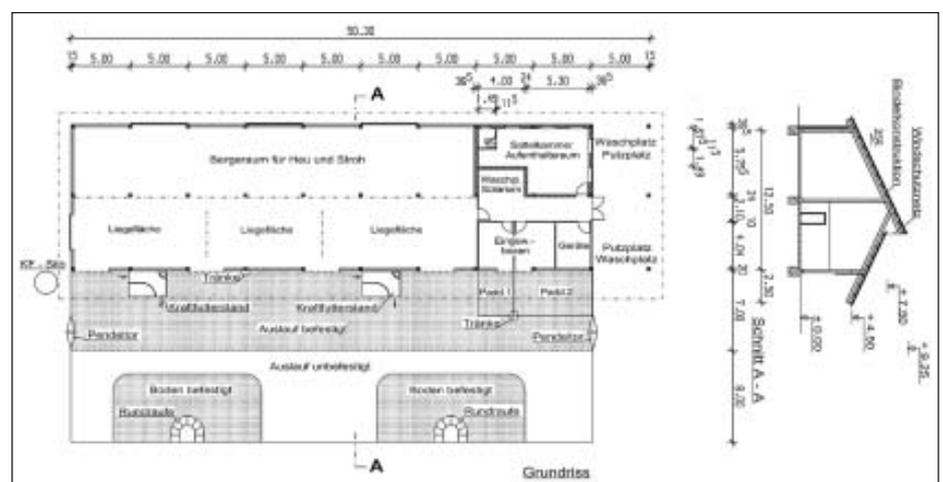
Grundriss und Schnitt der Großgruppenhaltung für etwa 24 Pferde
